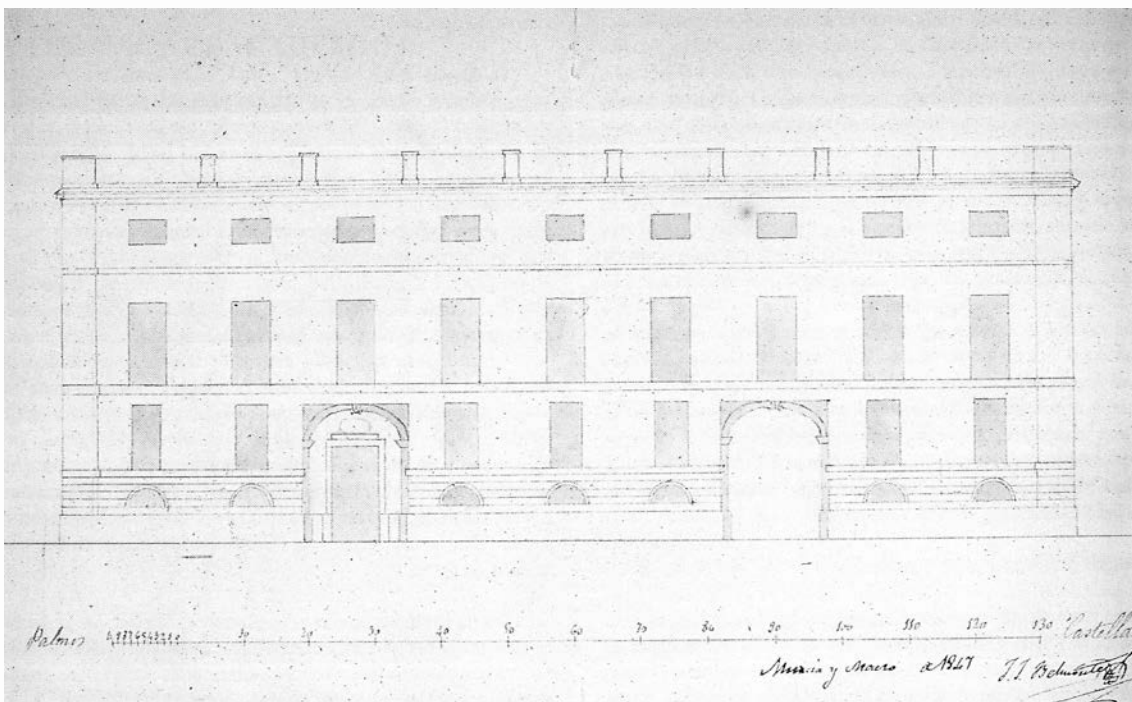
Alzado de la fachada a la plaza de Chacón (hoy, Santa Isabel), Juan José Belmonte, 1847
